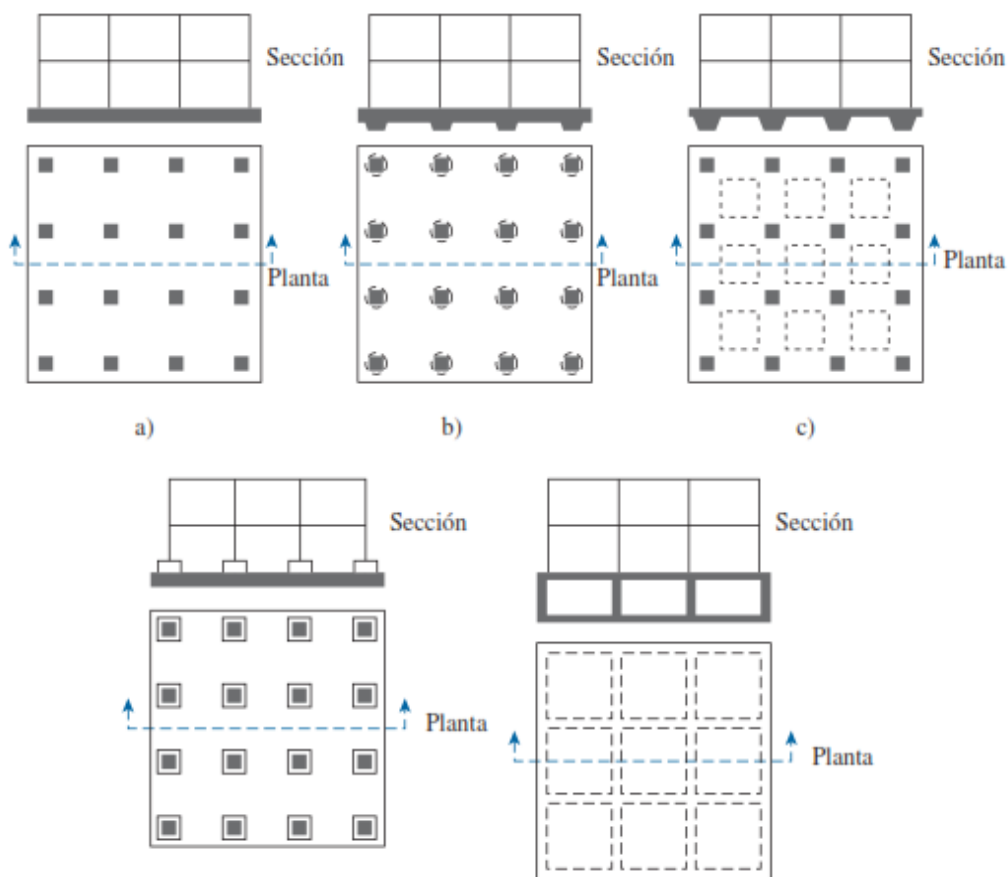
Tipos de Losa de cimentación, Adaptado de "Fundamento de ingeniería de cimentaciones", por Braja M. Das (2012)
